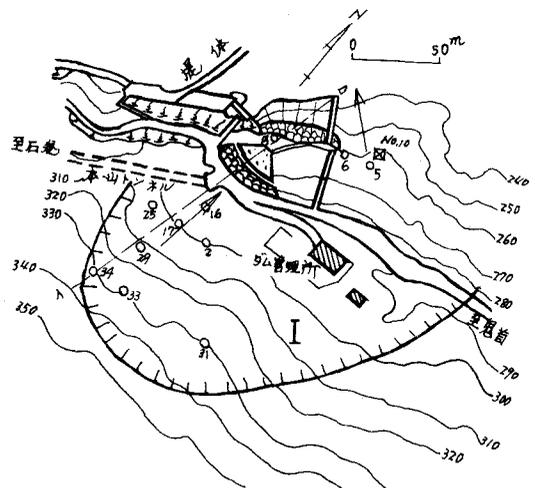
平面図 (○印は地下水位測定用ボーリング孔)
